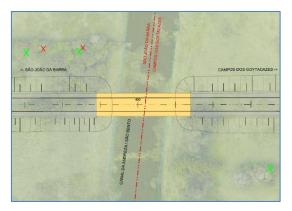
Solução para a transposição do Canal São Bento - Est. 400
